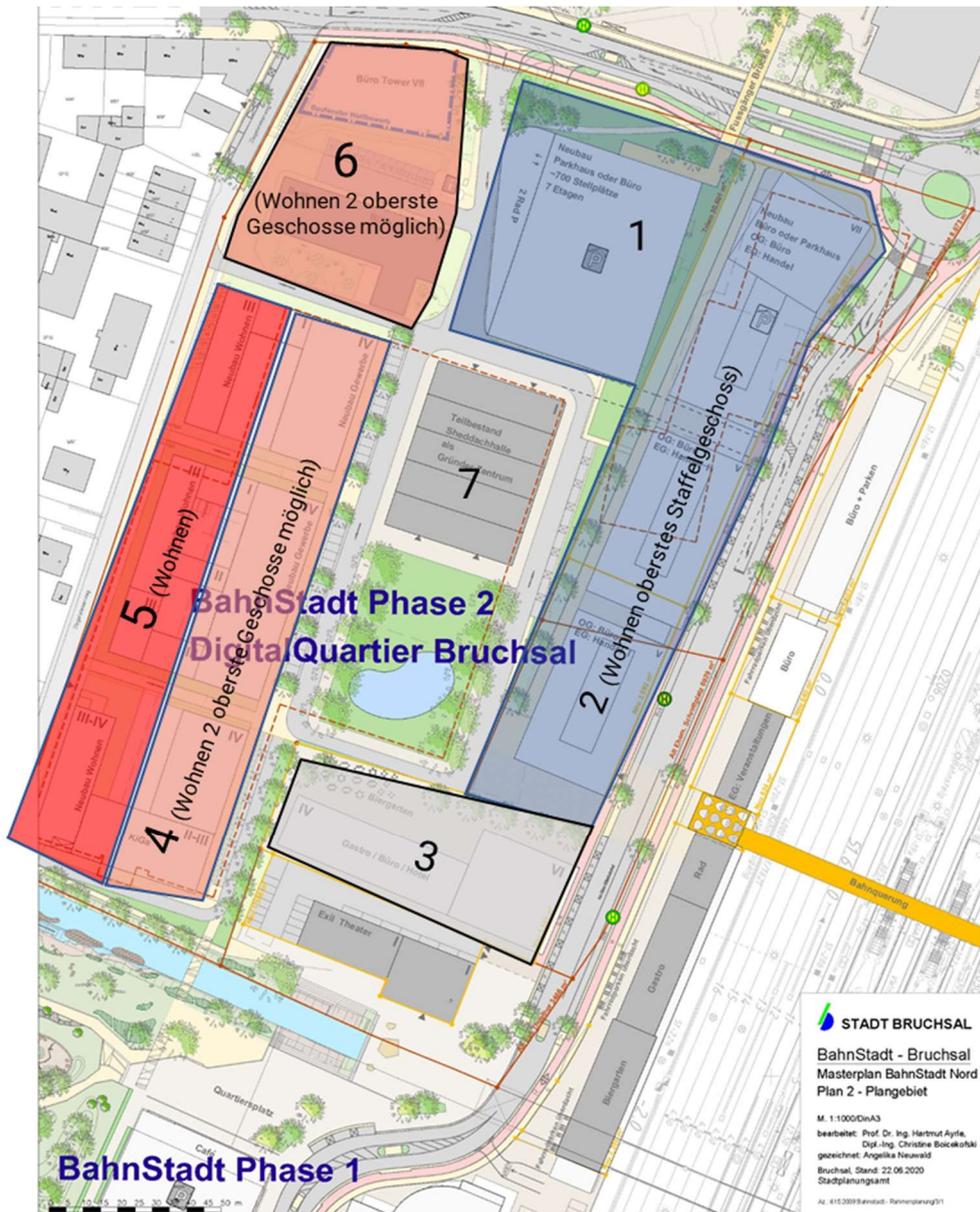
Zielplan Masterplan (ohne Maßstab)
